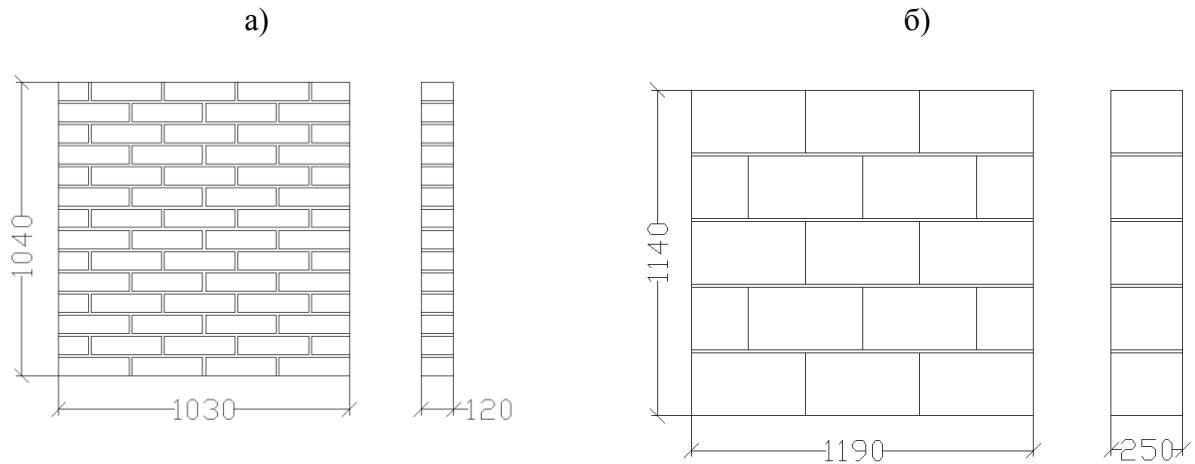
Фрагменты кладки стен для испытаний на перекус.
